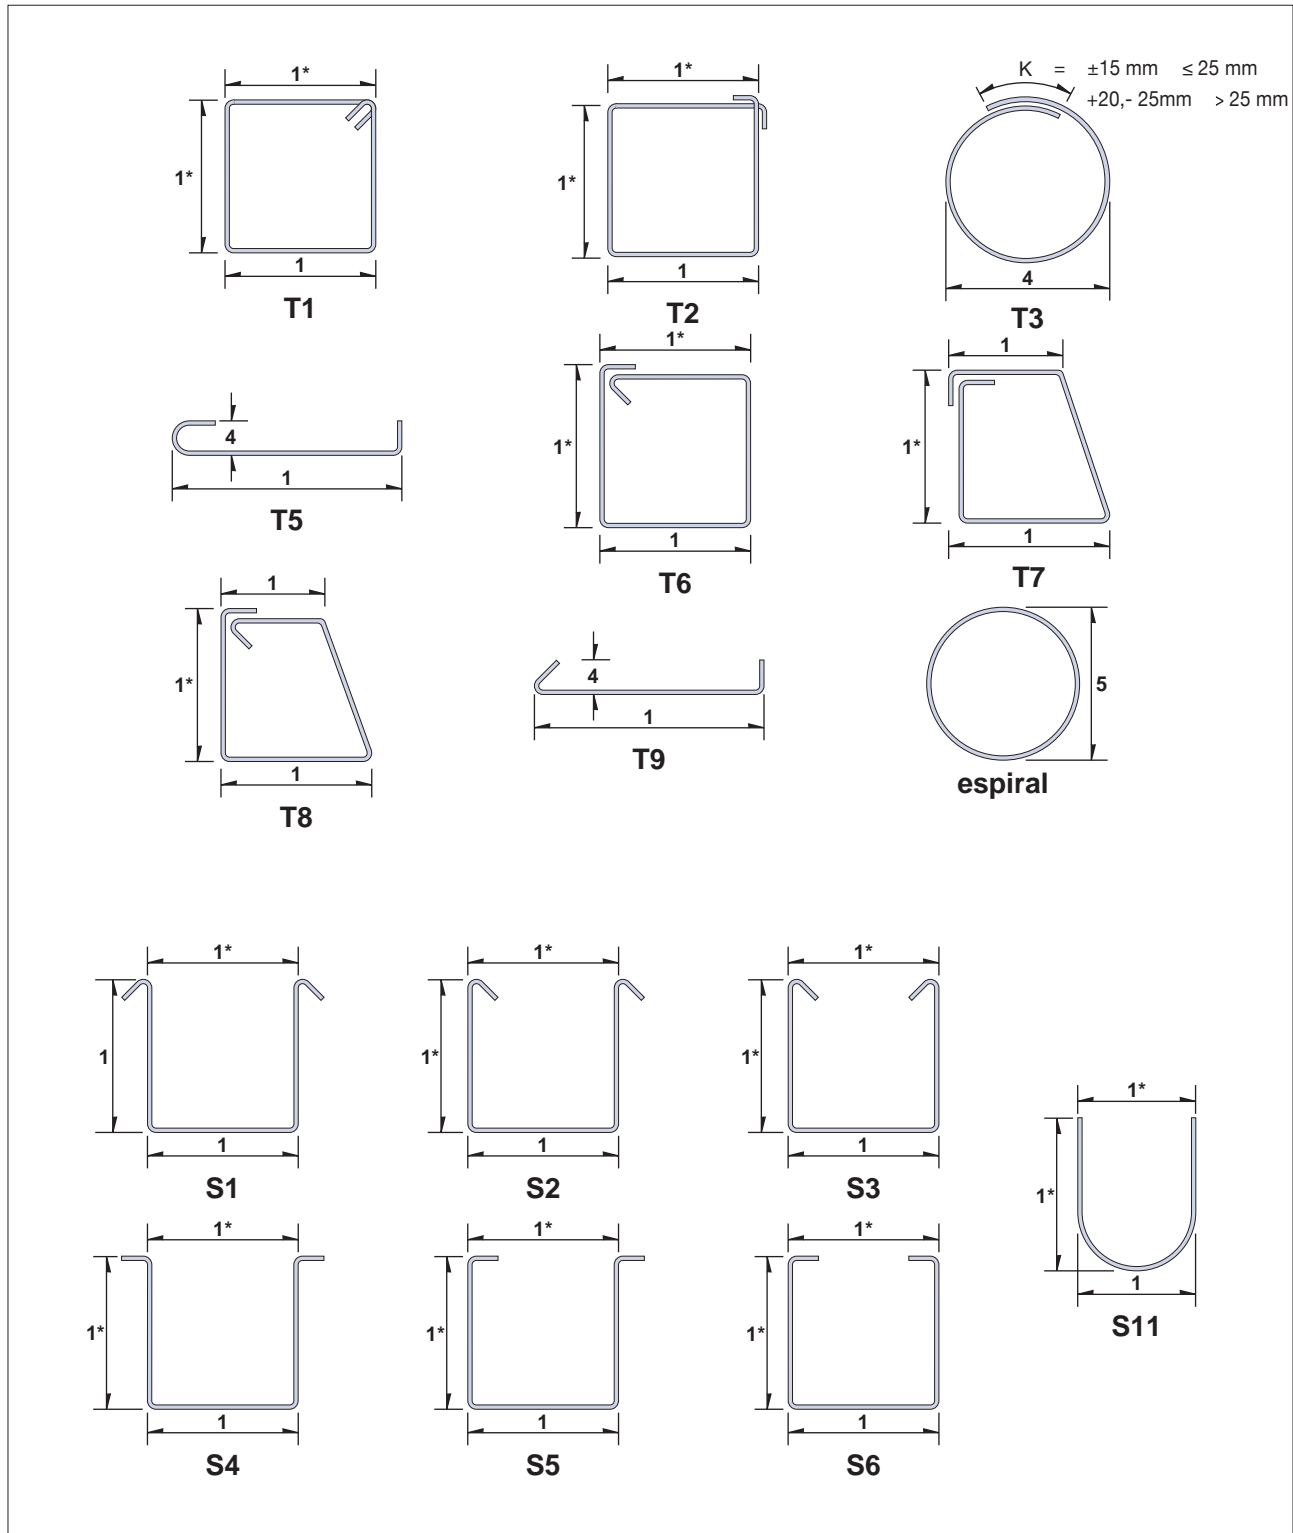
Tolerancias Estándar de Fabricación Estribos.
